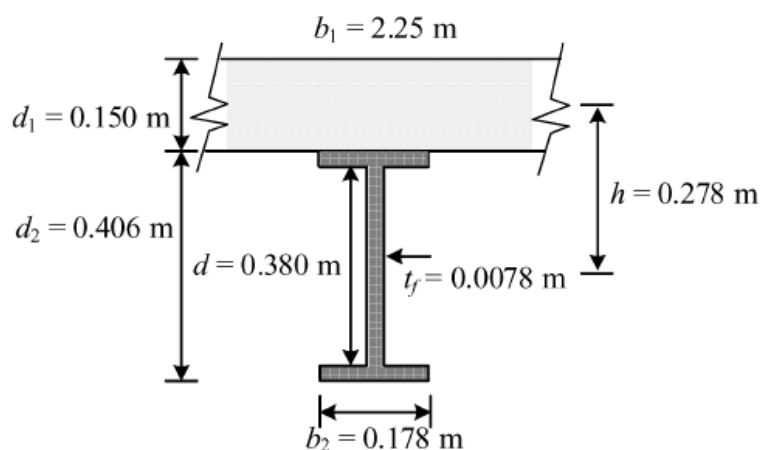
9 Viga mista – Exemplo 5.2.3.
